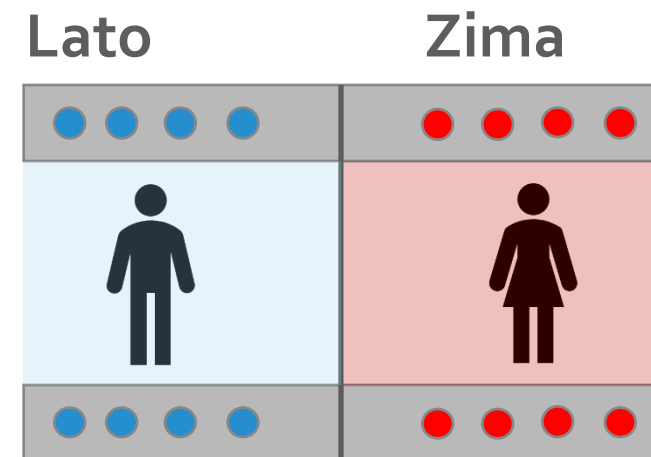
Instalacja ogrzewania podłogowego w konstrukcji stropu (element aktywny termicznie), źródło: beton-campus.de
